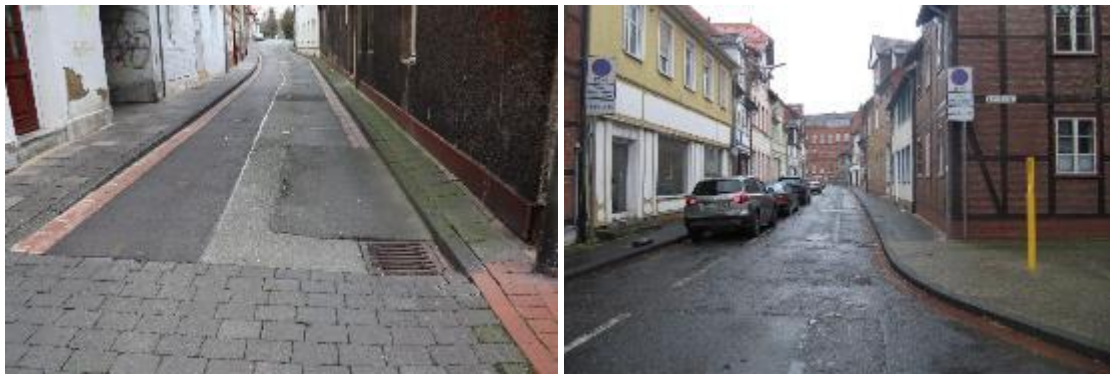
sanierungsbedürftige Straßenbelag der Walpurgisstraße (rechts) und Bötticherstraße (links)
